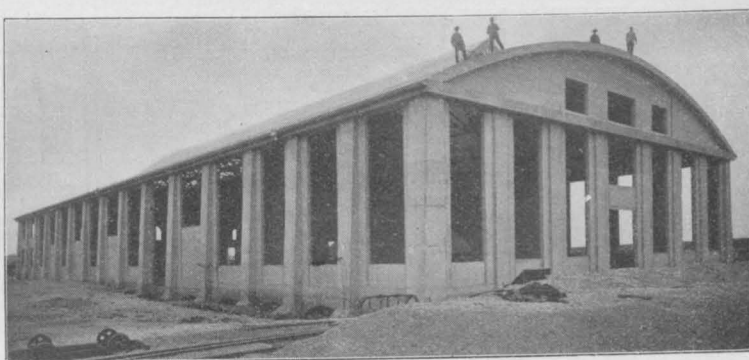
Hammerschmiede, im Eisenbeton-Rohbau fertig.
